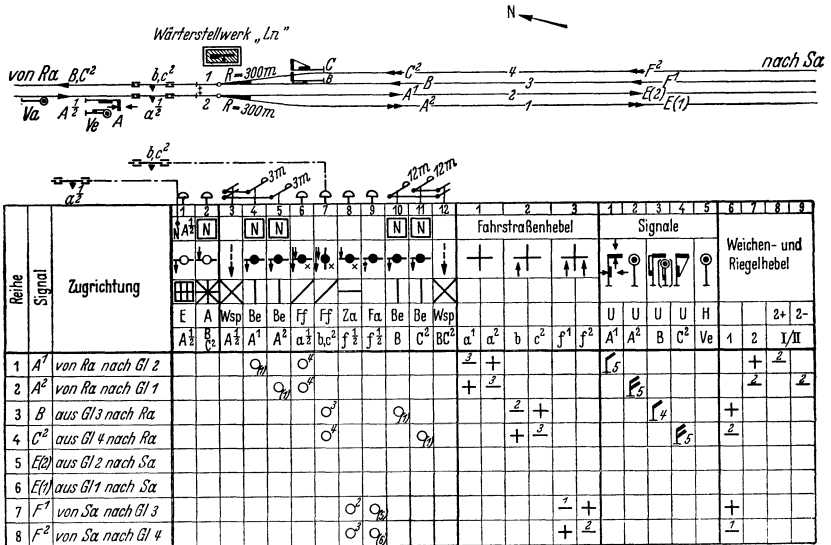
Lageplan und Verschlusstafel fur ein abhangiges Stellwerk.
